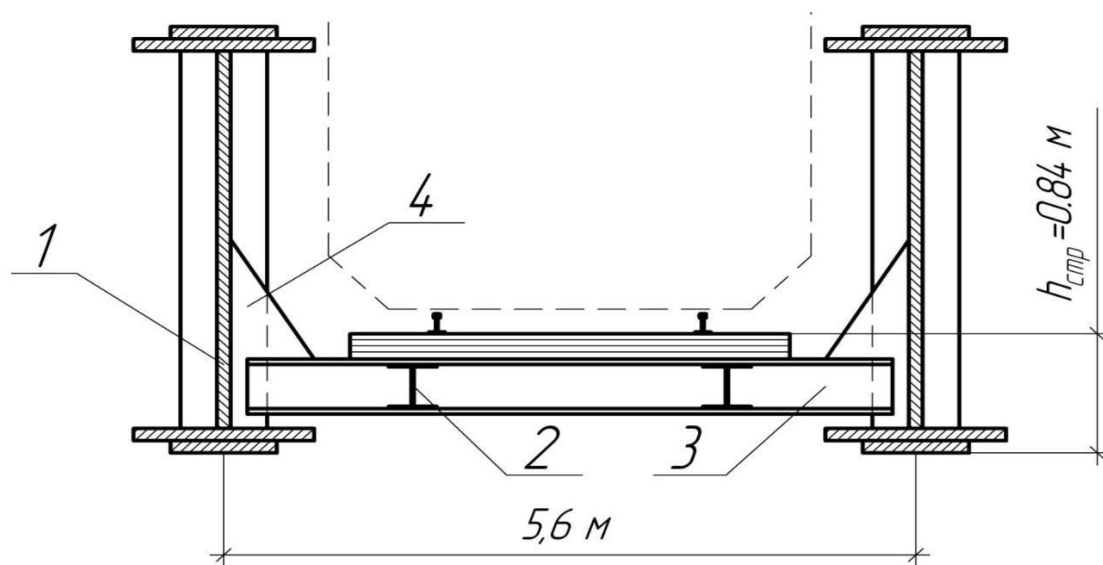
Схема поперечного сечения пролетного строения со сплошными стенками при езде понизу: 1 – лавная балка; 2 – продольная балка; 3 – оперечная балка; 4 – лист жесткости.
